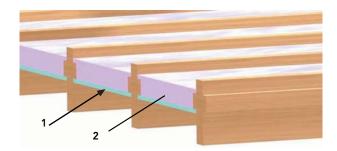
77: Colocación de aislación termo-acústica, entre el listoneado de cielo sobre la plancha de yeso cartón para luego colocar el tablero estructural, arriostrando la estructura de plataforma del entrepiso.
